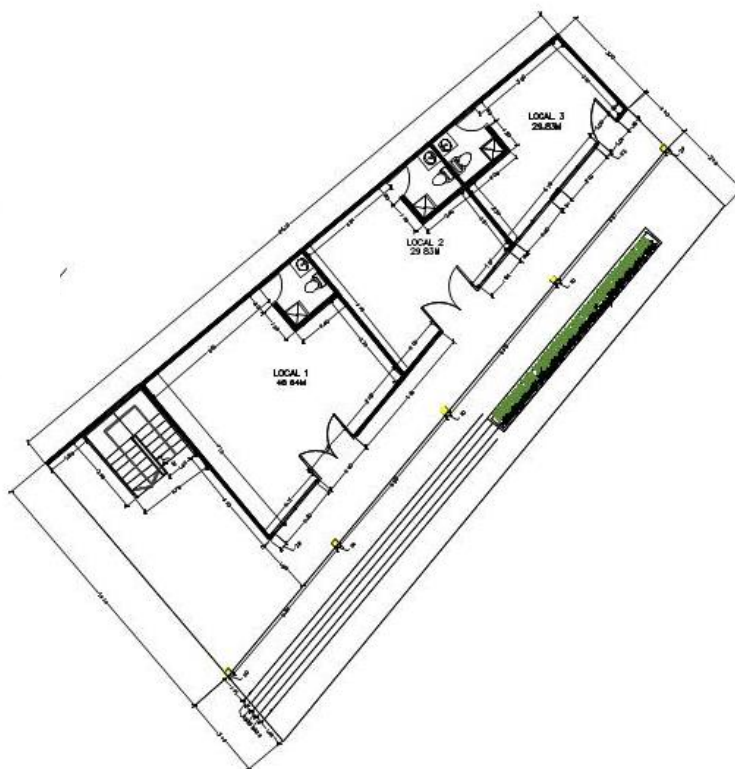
Planta Arquitectónica de la planta baja (nivel 000)
